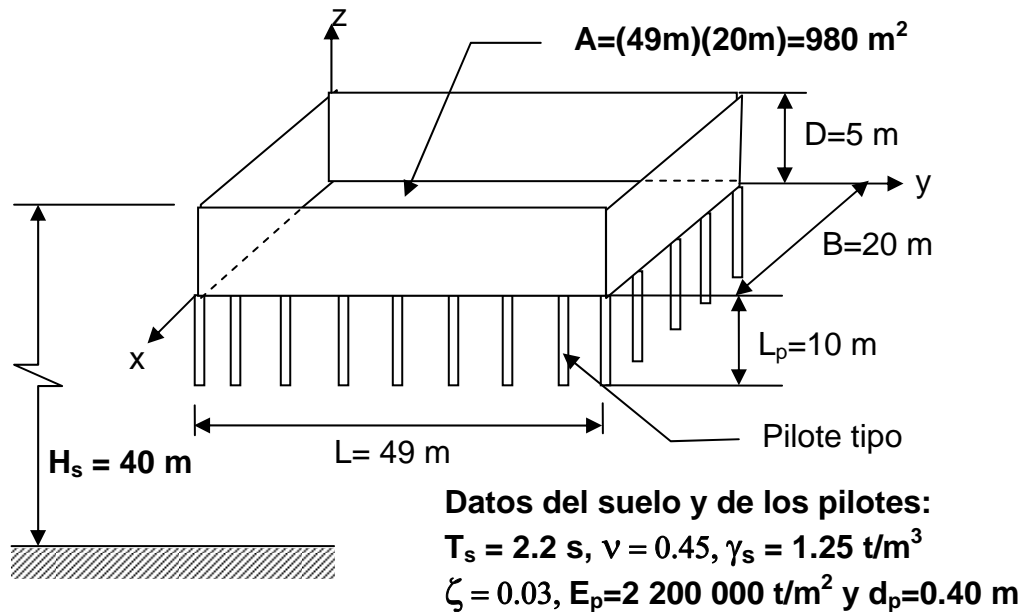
Cimentación mixta del edificio de 14 niveles.
